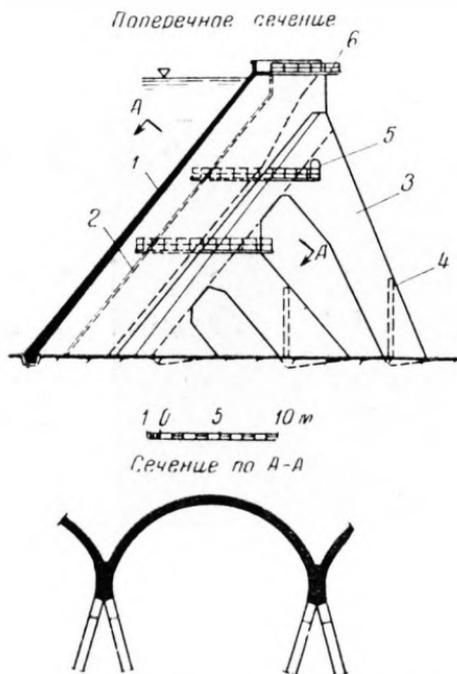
Типовая конструкция железобетонной многоарочной плотины
